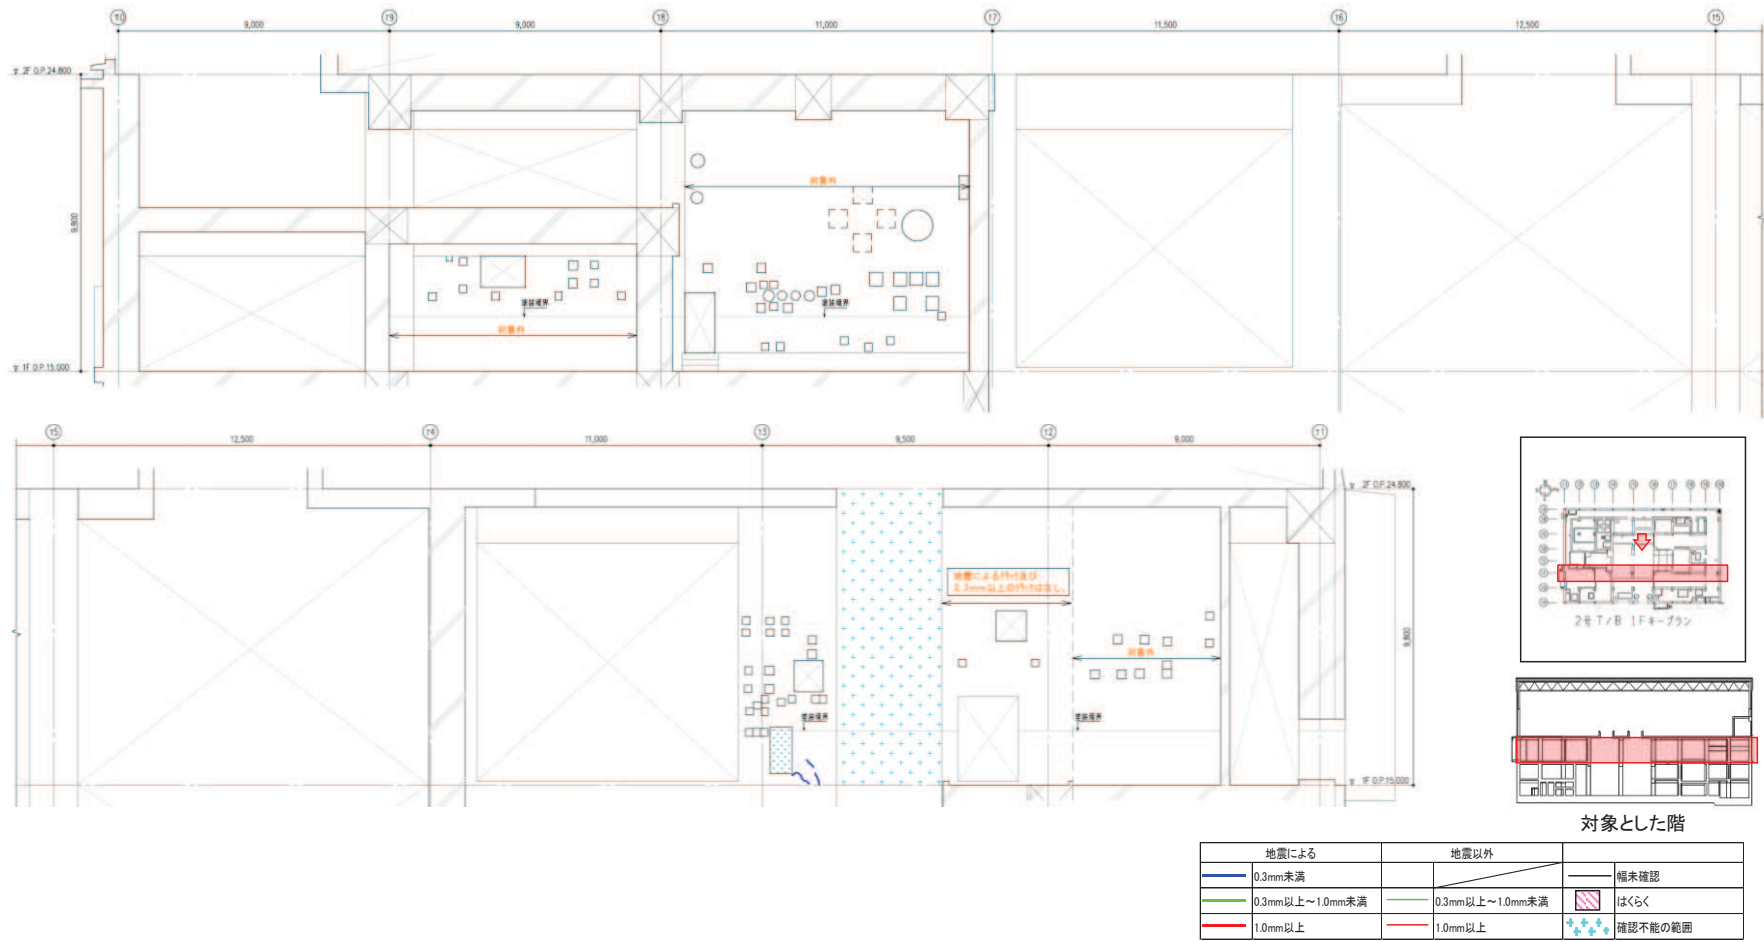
タービン建屋のひび割れ分布 耐震壁 (46) 1階 TF 通り
